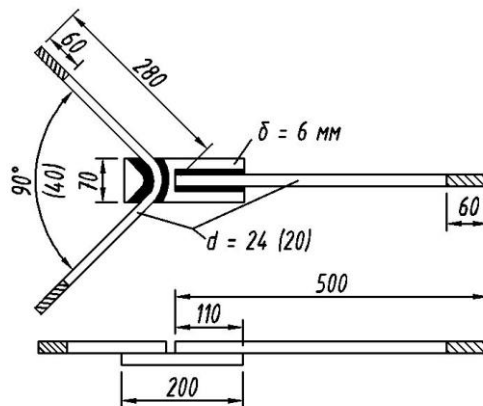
Стальная деталь крепления верхнего и нижнего поясов косяка №1 к фронтовой арке. Размеры в скобках относятся к детали нижнего пояса
